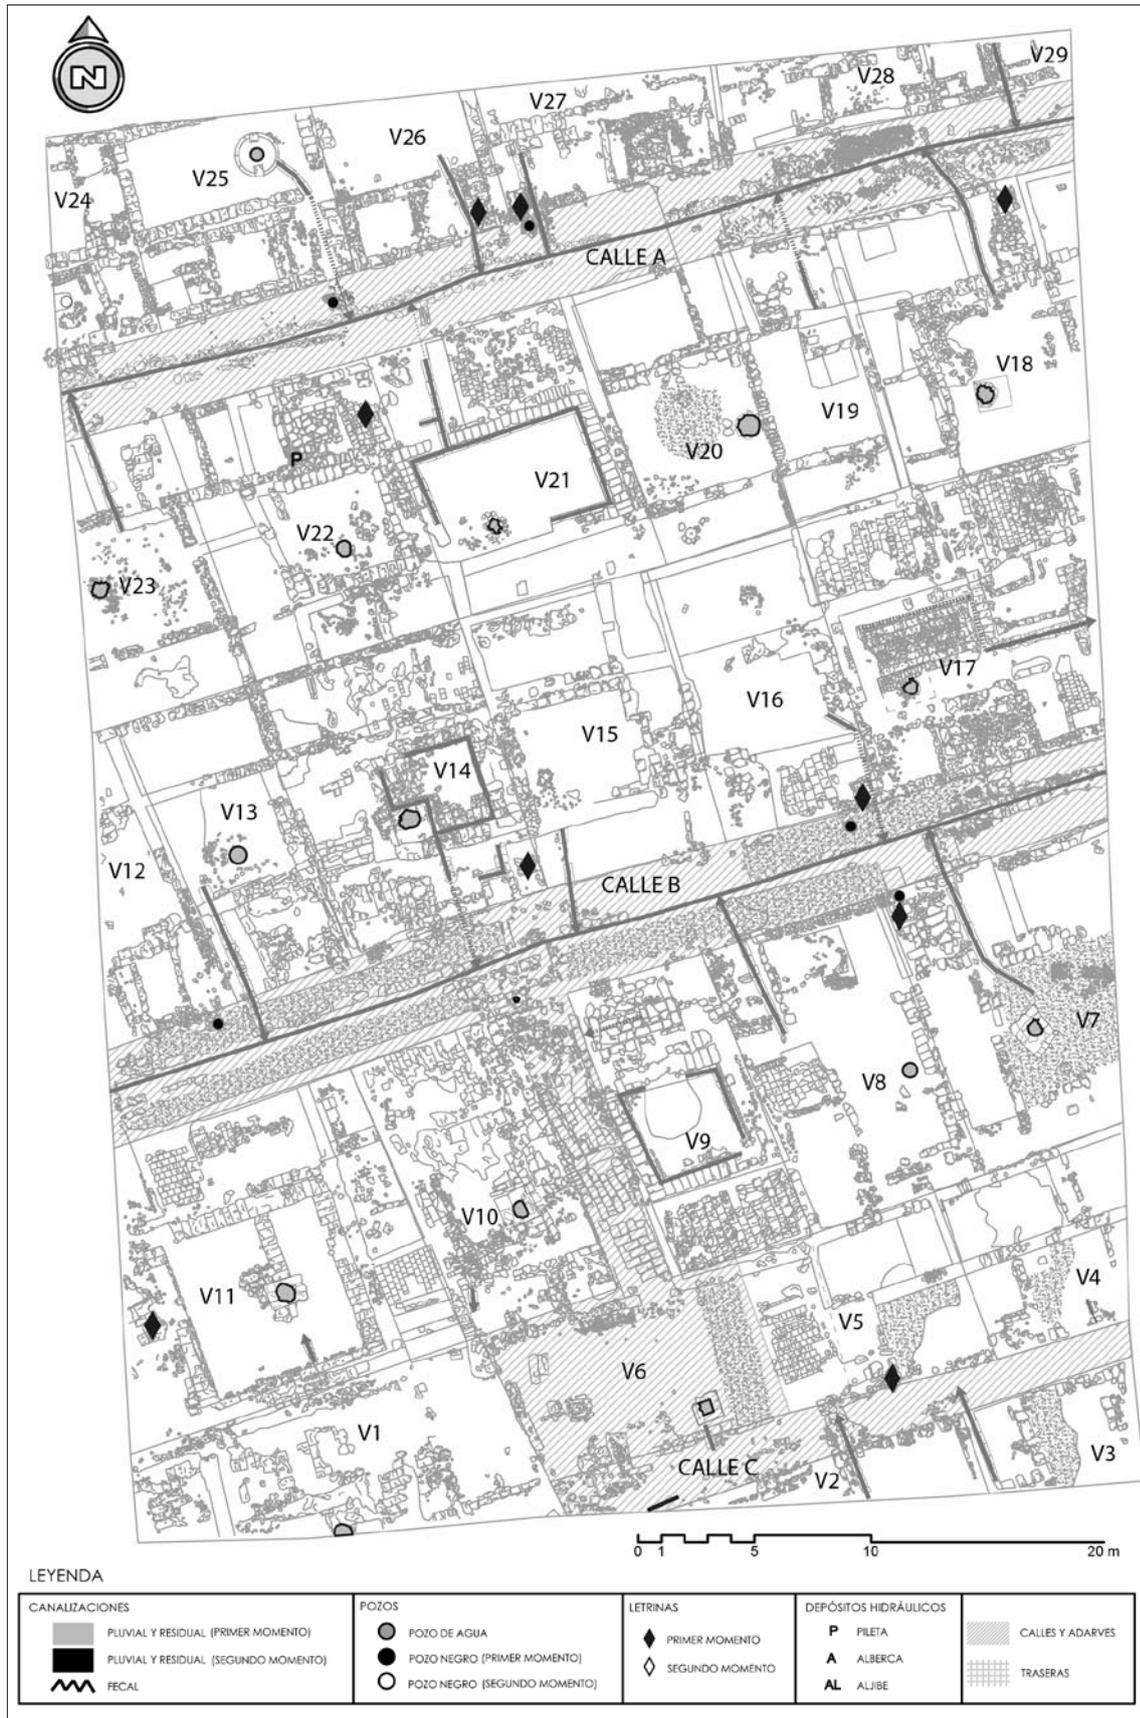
Planta general de la manzana 16.B del P.P. O-7 e instalaciones hidráulicas documentadas (sobre planimetría de D. Gaspar, en LÓPEZ, 2008).
